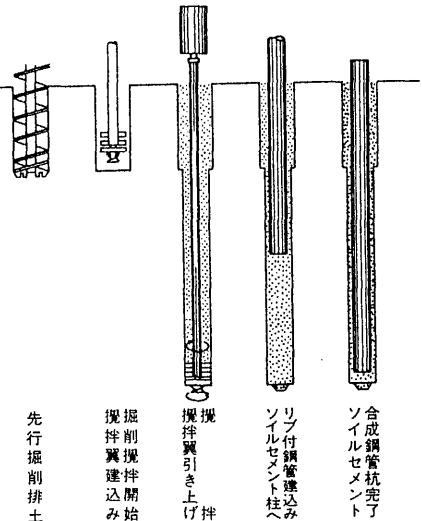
ソイルセメント合成鋼管杭工法の施工概要図
